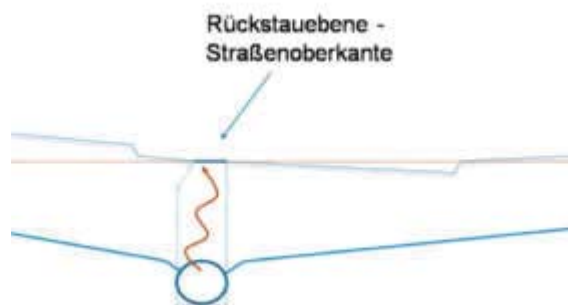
Rückstauenebene, festgelegt als Straßenoberkante an der Anschlussstelle an die öffentliche Abwasserleitung
